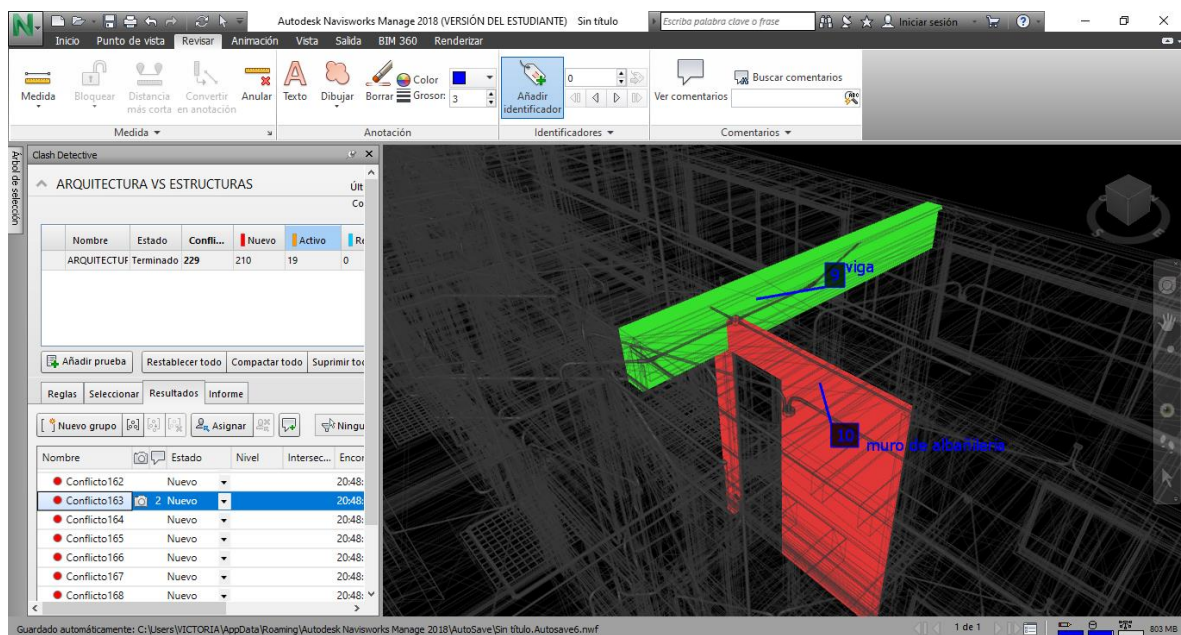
Interferencia entre viga estructural y muro de albañilería.
